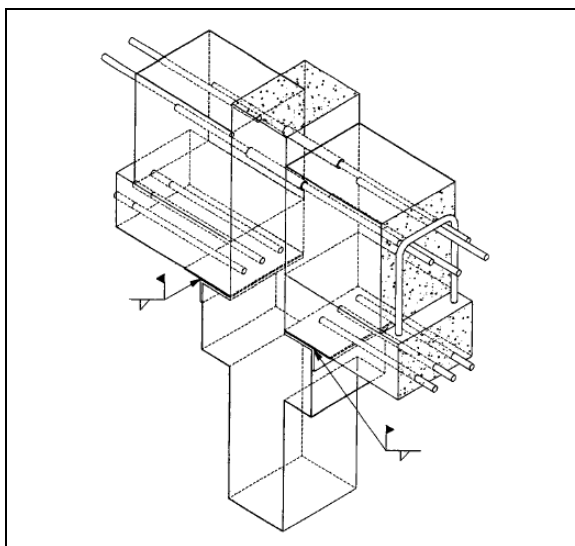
Ligação por consola curta de betão e armadura com ligadores (PCI, 1999)
